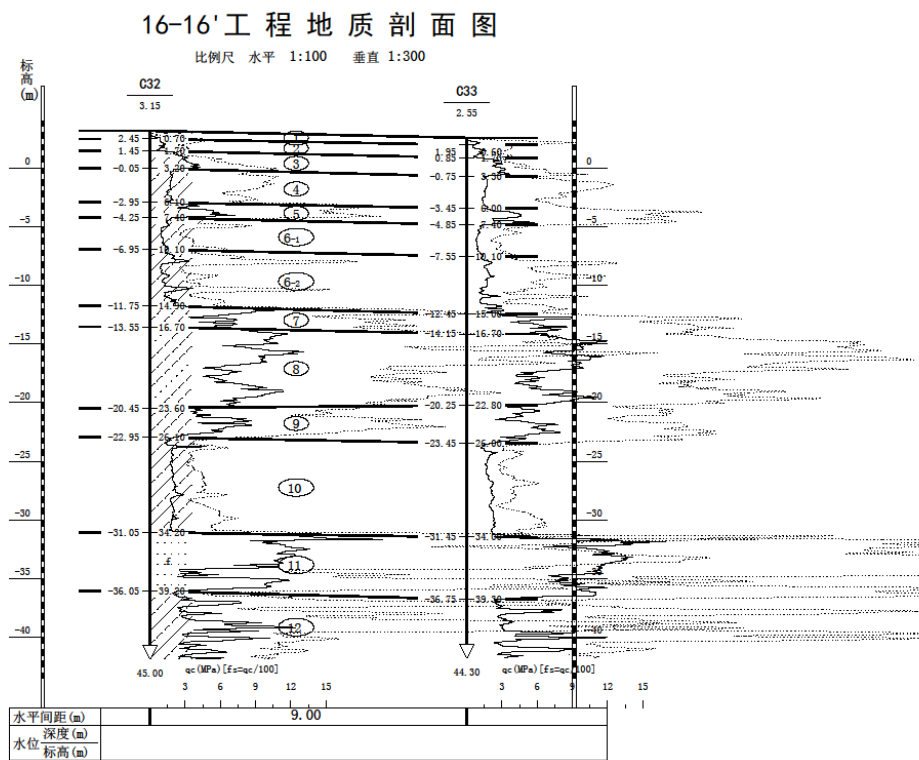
垃圾渗滤液处理站地质剖面图
